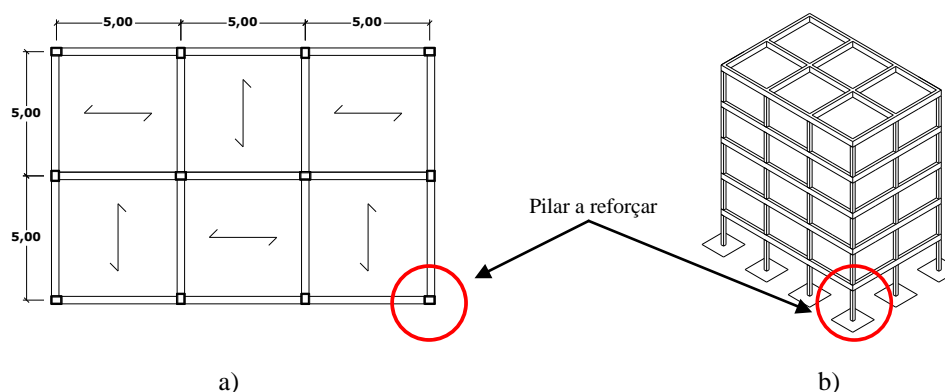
a) - Planta do edifício e amarração das lajes; b) - Esquema do edifício.
